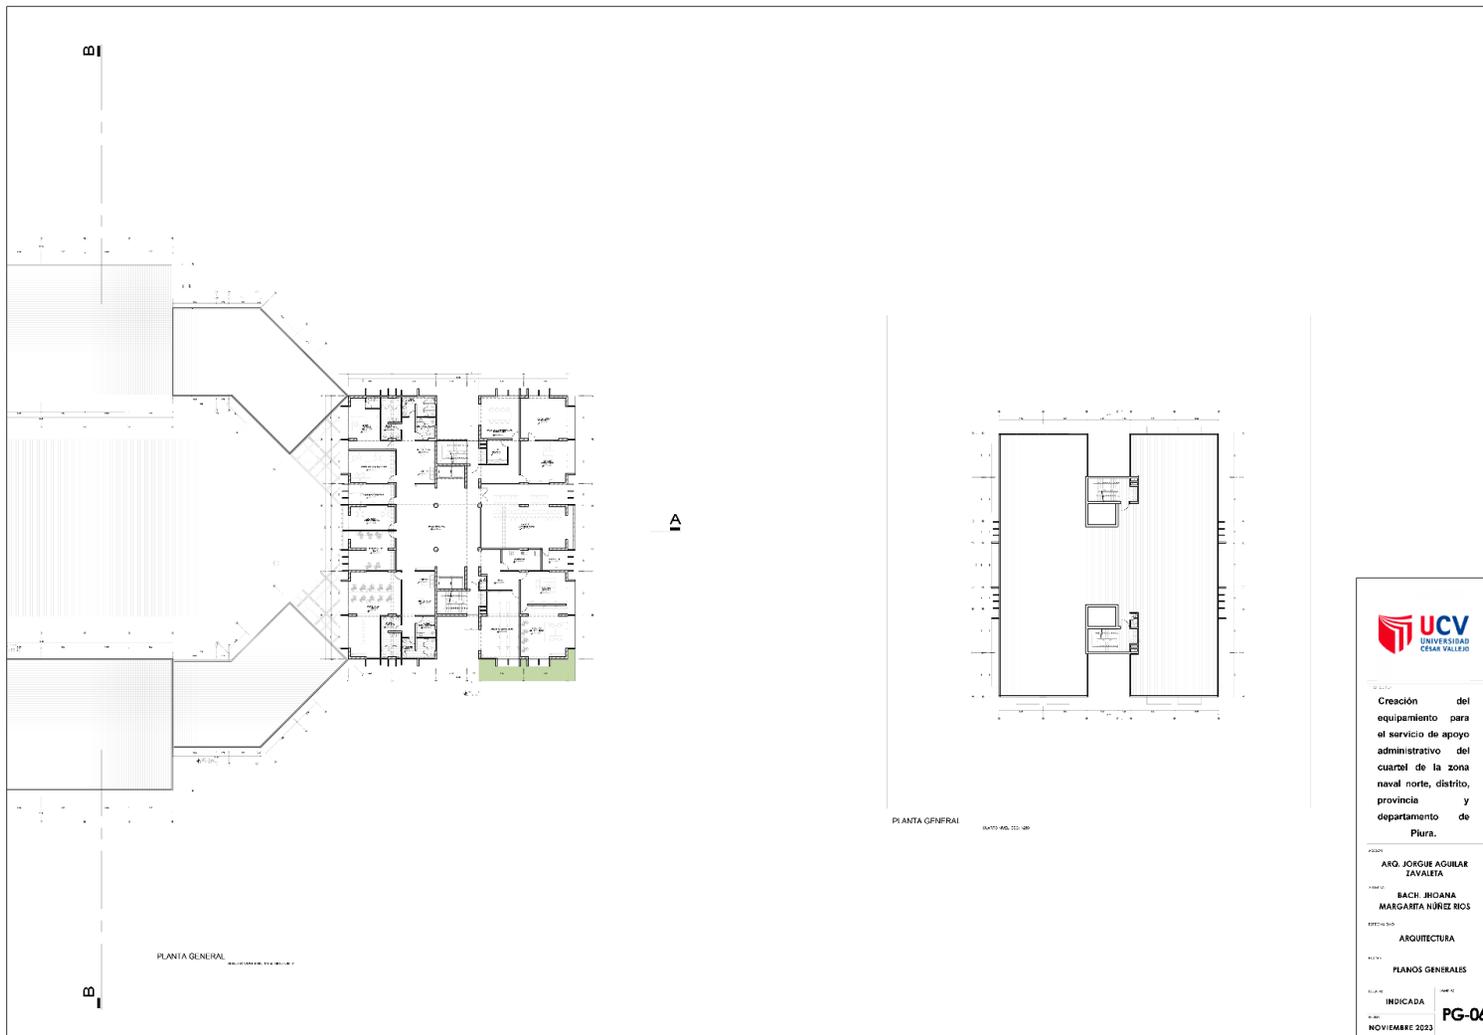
Planos Generales - Plano genera del tercer nivel – SECTOR 2
